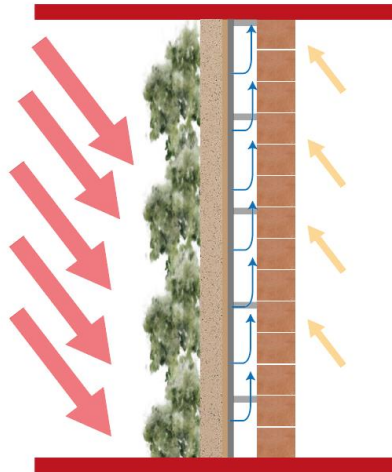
Detalle constructivo del aislamiento con mortero térmico
